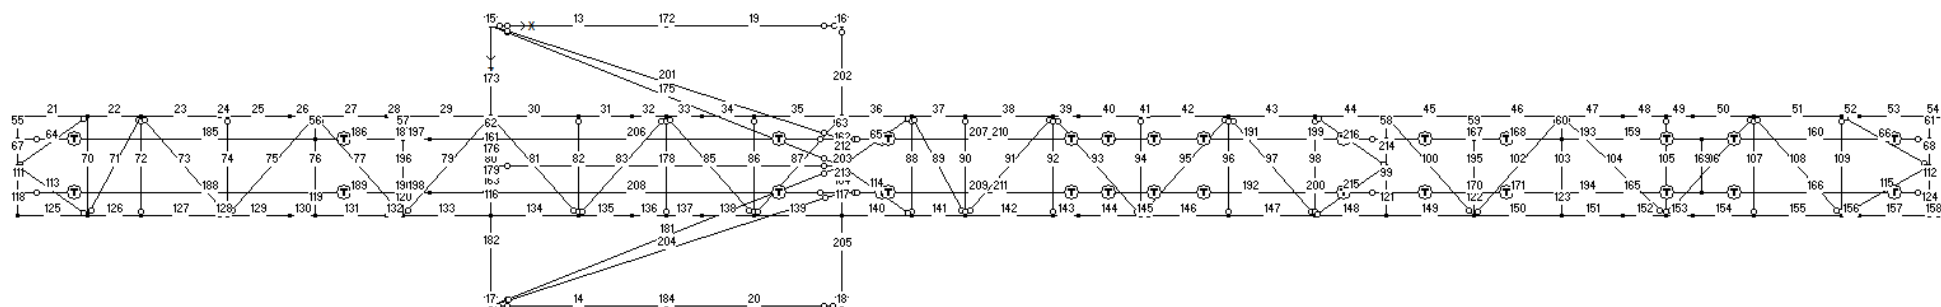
Identificação dos elementos estruturais do pórtico de cais (vista de topo)
